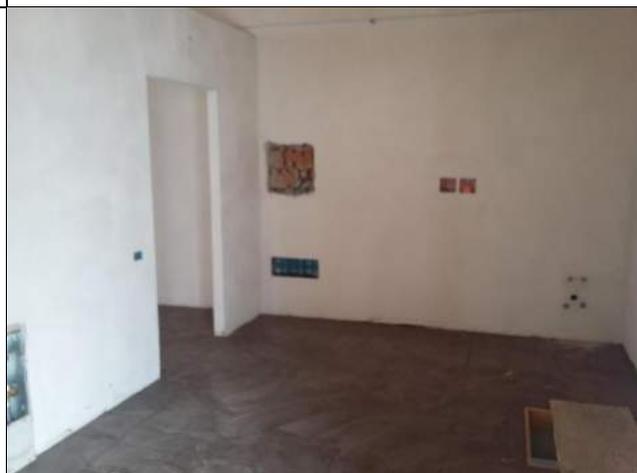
primo piano: zona impiattamento collegata con la cucina tramite apposito montacarichi.
